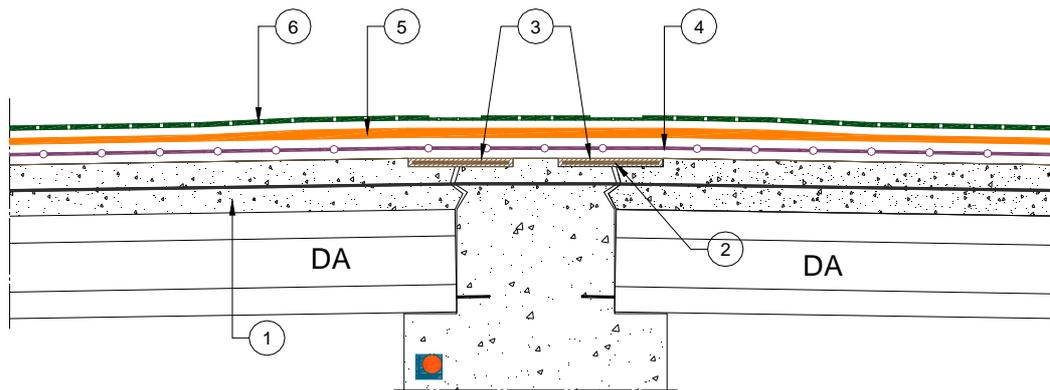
Fissure active sur appui en plancher de type D
